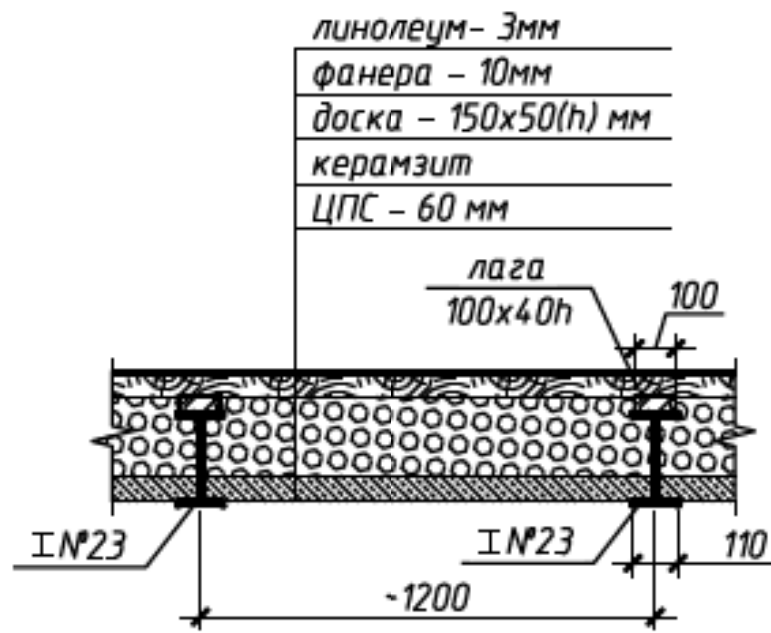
Вскрытие 6 (пол 3-й этаж)
